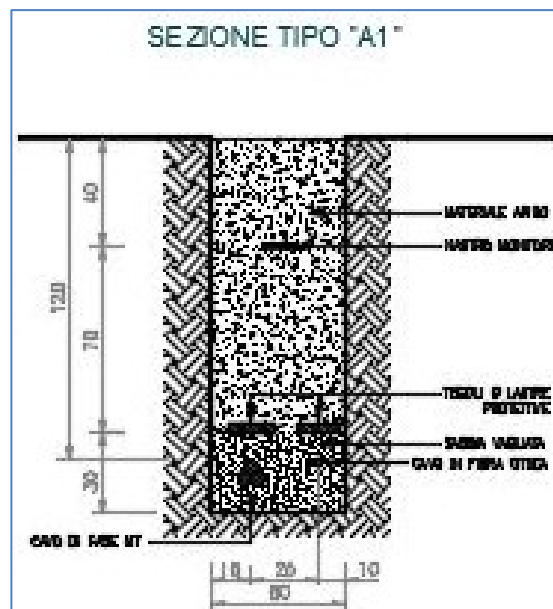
Sezione tipica di posa della linea di cavo su strade sterrate
